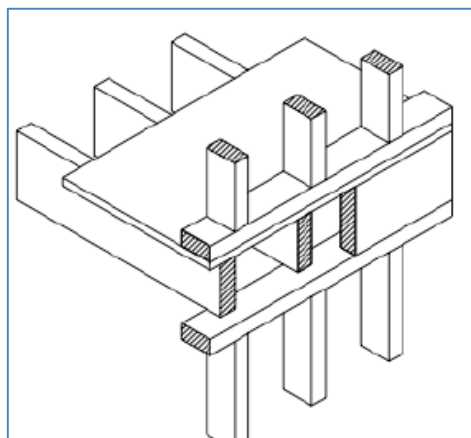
Detalle del encuentro del muro con el forjado en el sistema de plataforma.
